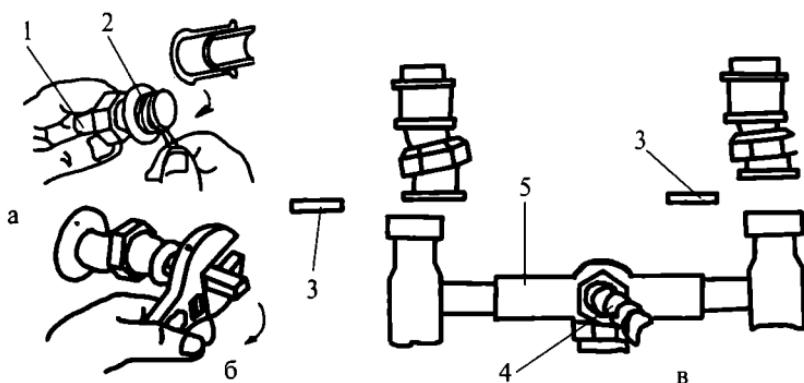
Смеситель с вертикально расположенным кнопочным переключателем и его монтаж на трубопроводах: а — наматывание нитей уплотнения на патрубок; б — заворачивание патрубка; в — подсоединение корпуса к патрубкам, заворачивающимся постепенно в муфты трубопроводов; 1 — патрубок; 2 — декоративная шайба; 3 — уплотнительное резиновое кольцо; 4 — гибкий шланг; 5 — основание
